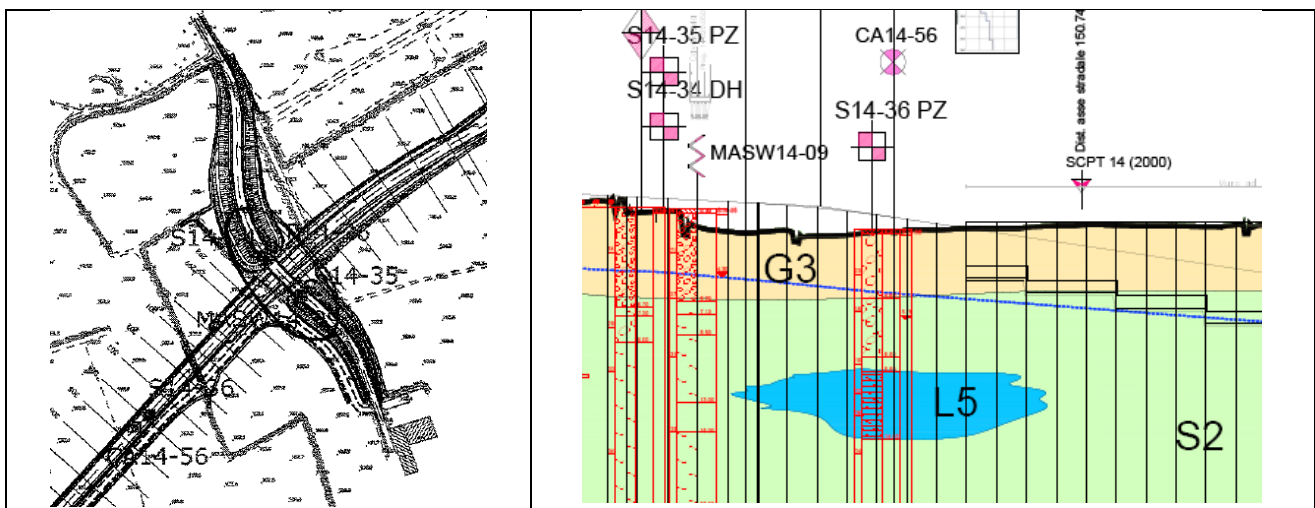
Stralcio planimetrico e stralcio profilo geologico Cavalcavia deviazione SP183
